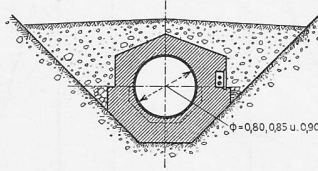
Querschnitte durch die Wasserführungsanlagen, Masstab 1 : 100
